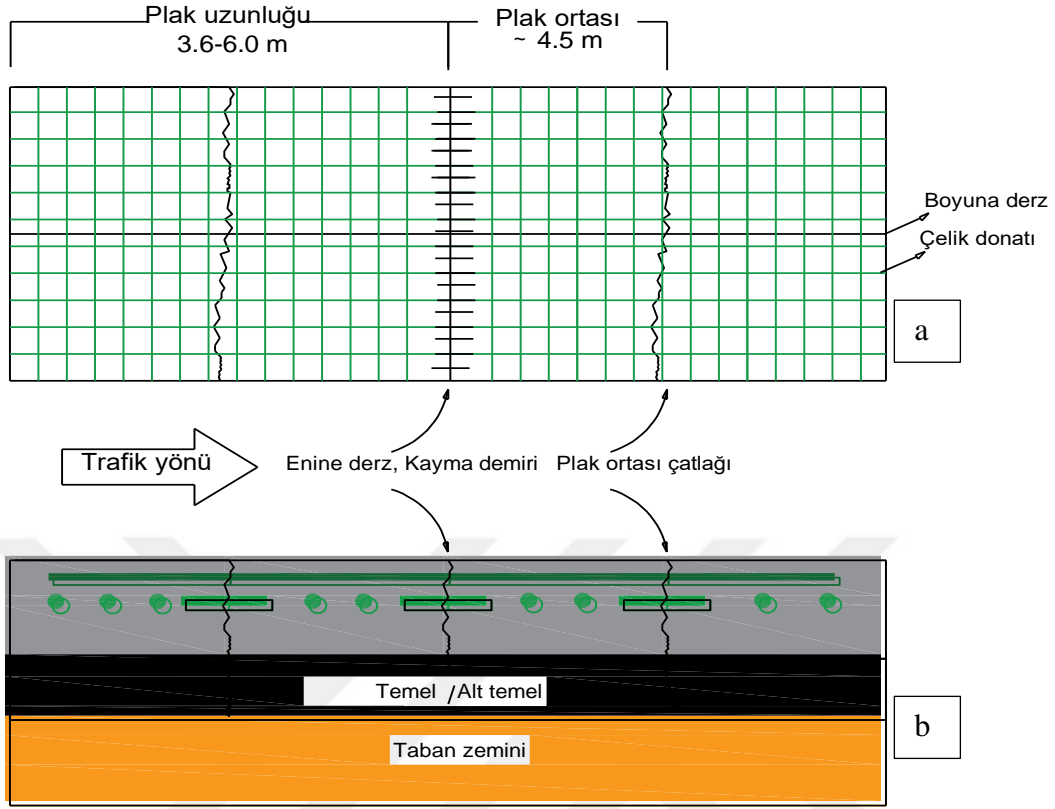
Derzli donatısız beton kaplamaya ait kesit (a) ve plan (b) görüntüsü (URL-3).
